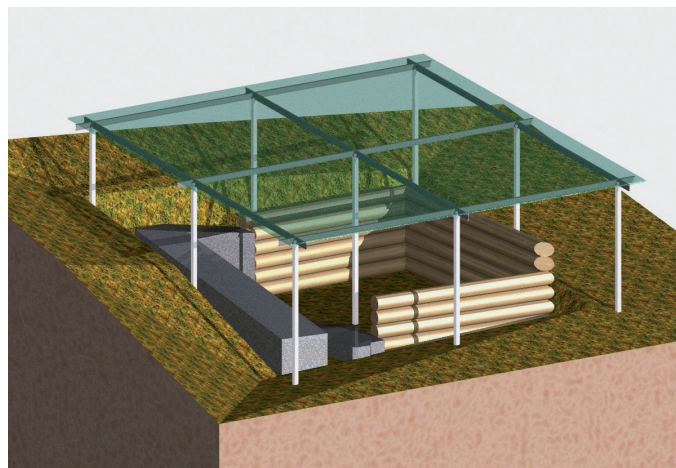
Plan des Schutzbaues und der Rekonstruktion von Haus X
